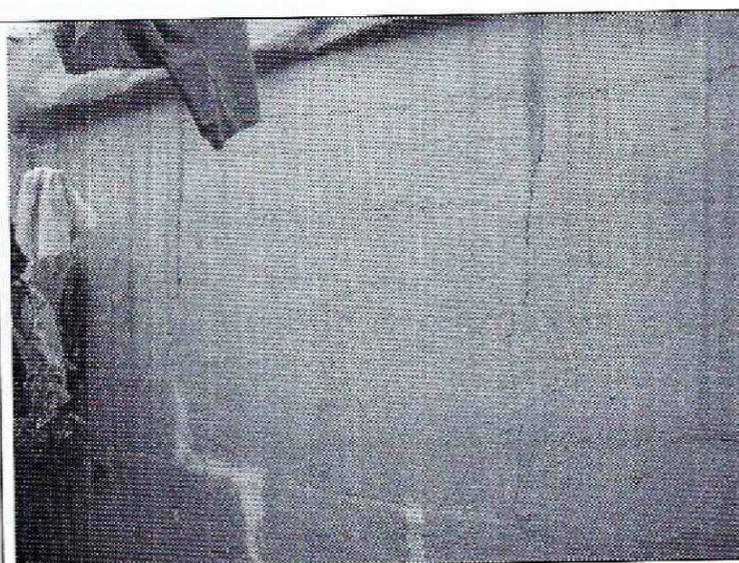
Detalle de los daños de uno de los muros de cerramiento del patio posterior de la vivienda.
